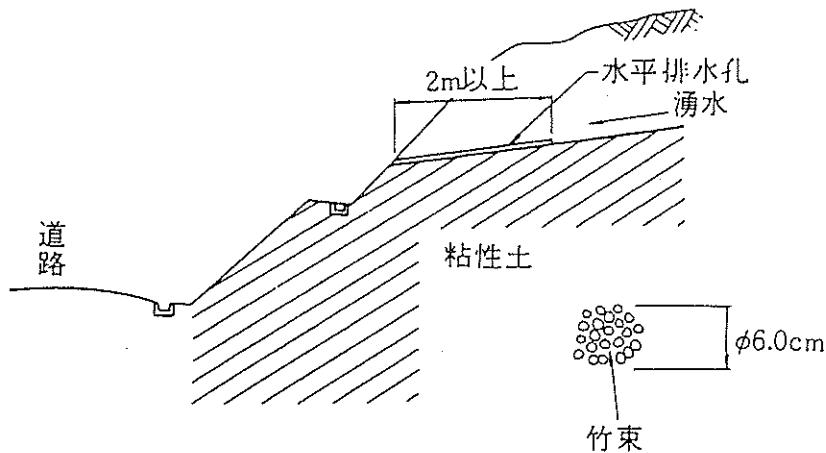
水平排水孔（出典：社団法人 日本道路協会編（1987年）；
